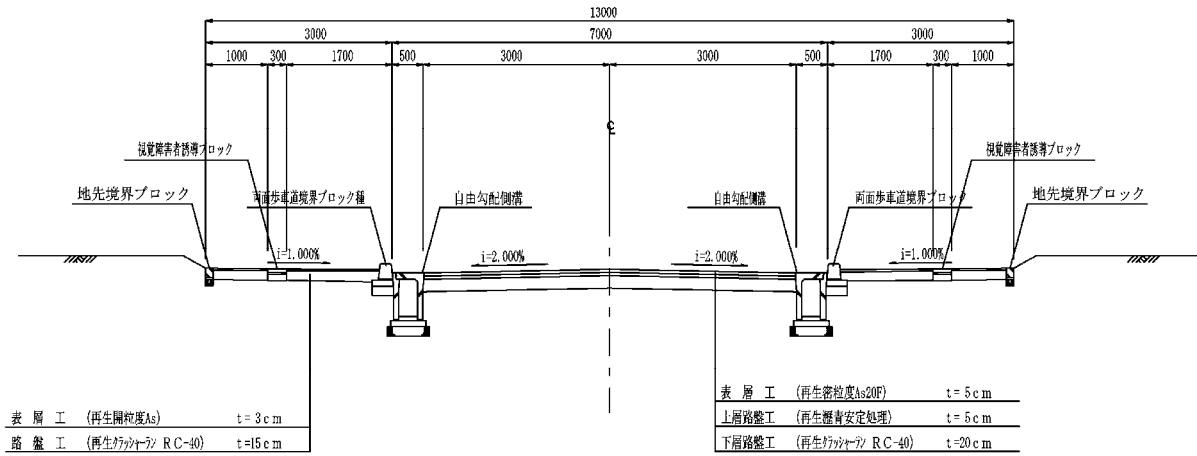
(3) 道路標準断面図(補助幹線道路:13m)
